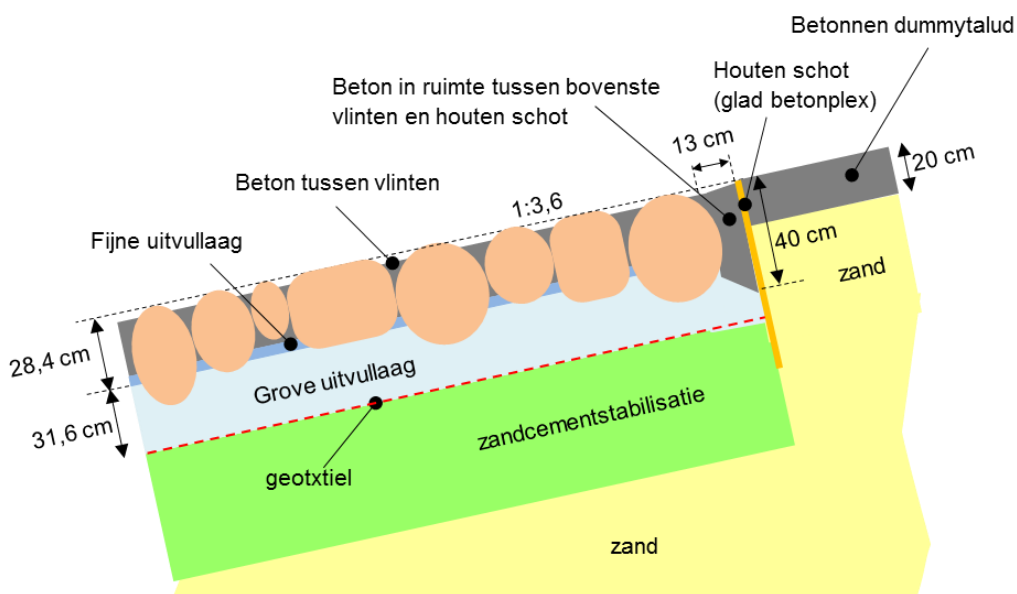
Langs de bovenrand van de testsectie is een strook ongewapend beton gestort tussen de vlinten en het gladde betonplexen schot.
